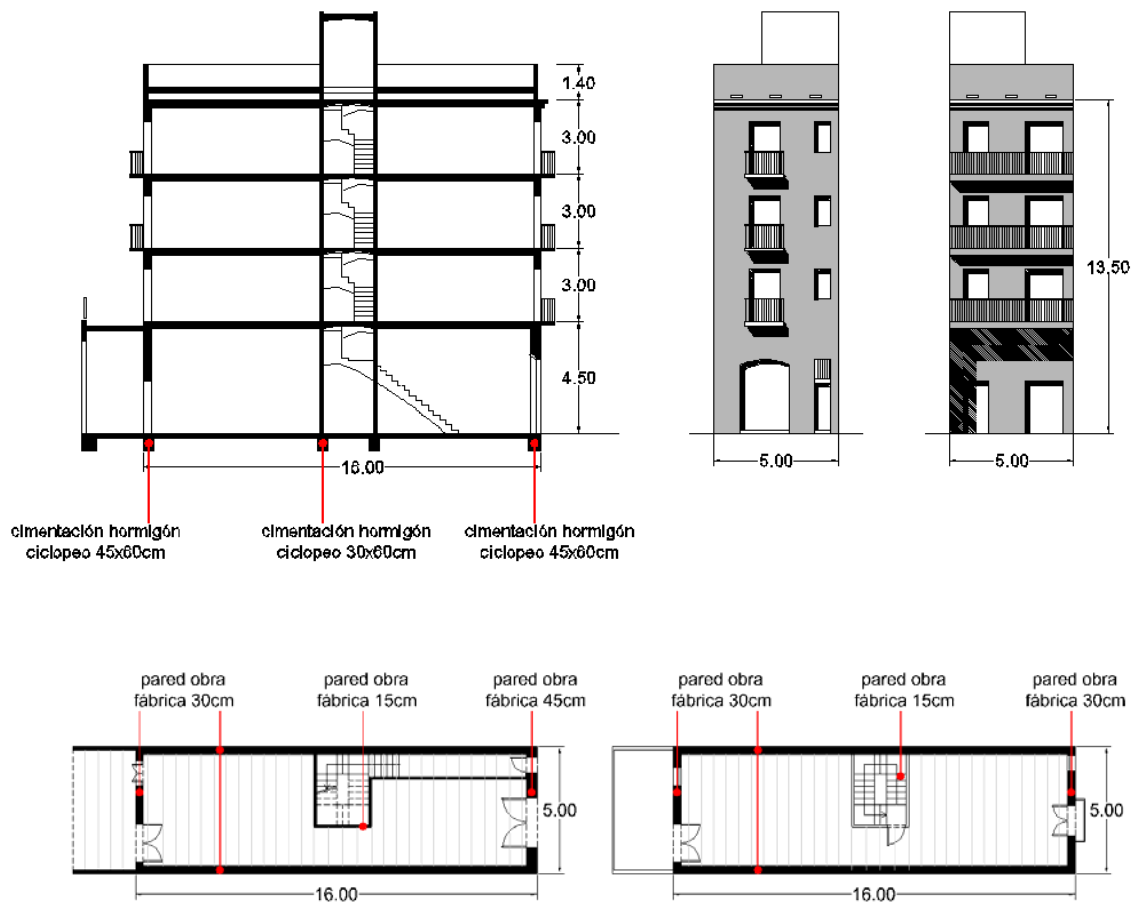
b Plantas, alzados y sección del modelo I.3
